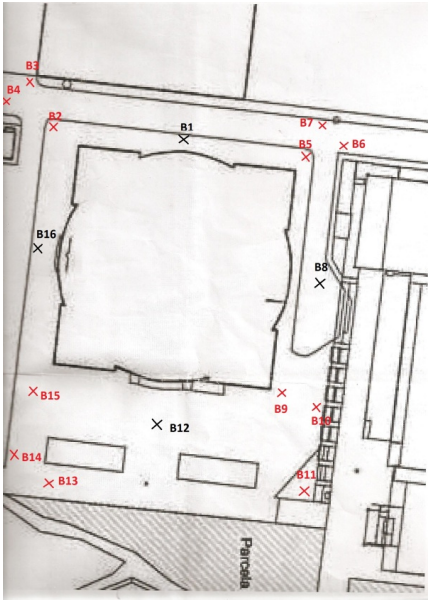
Croquis con las bases que se han utilizado para el levantamiento, 2012. La Autora.
